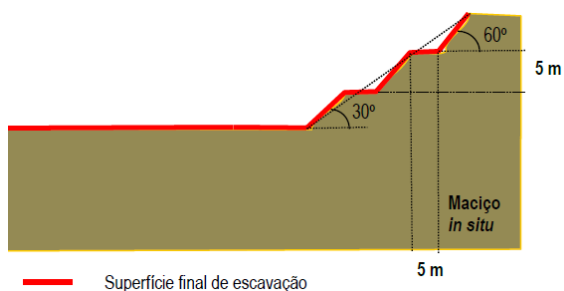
Perfil esquemático da configuração final da escavação. (Fonte: RS)
